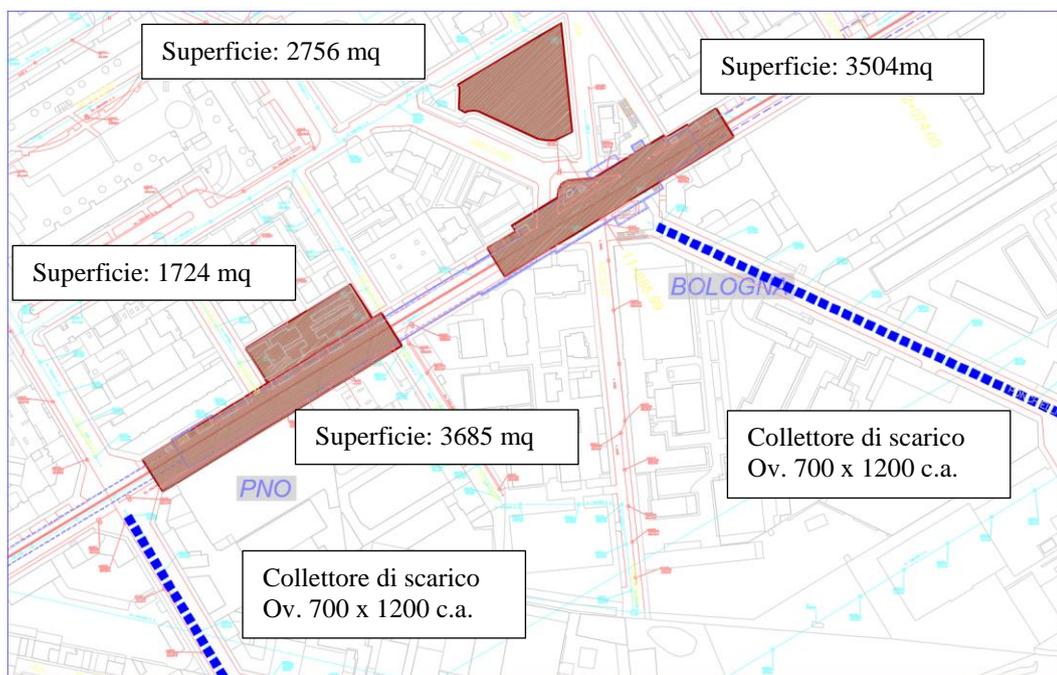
Aree di cantiere – Stazione Bologna – FASE 3B
